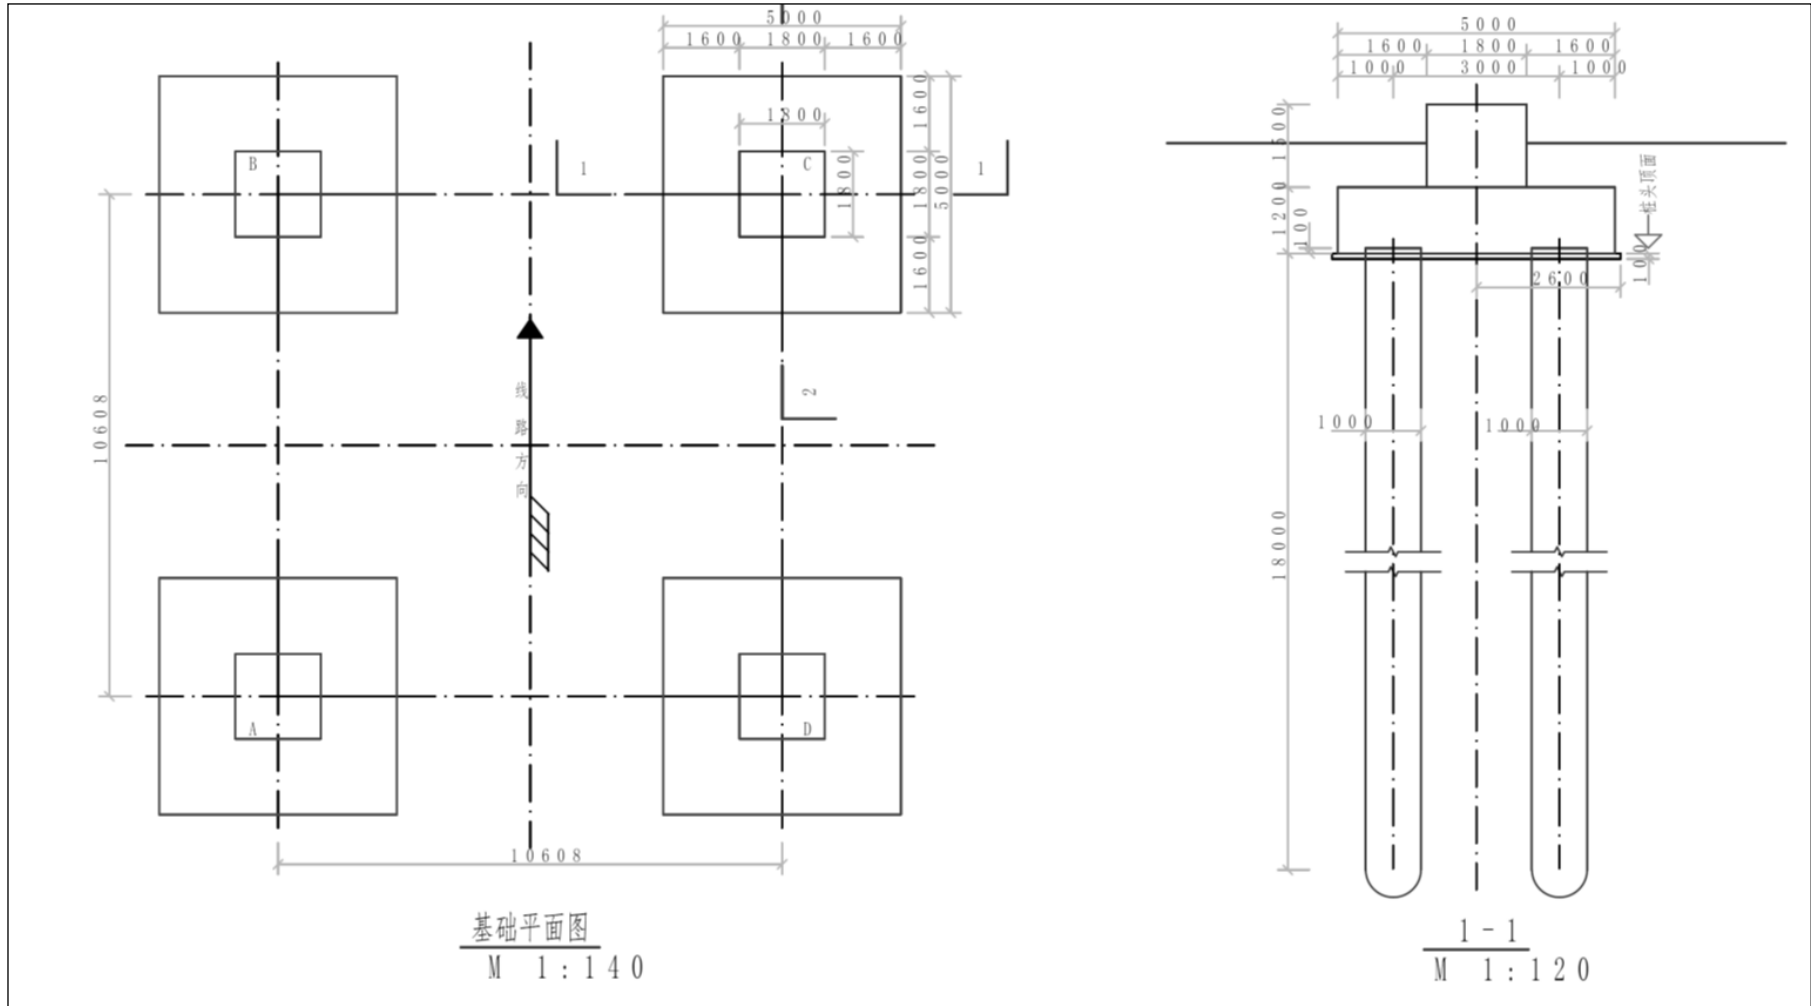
跨大产港段线路杆塔基础平面图和纵断面图
